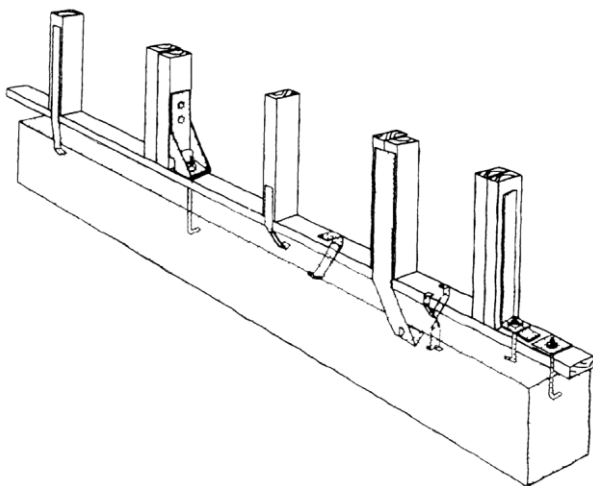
Виды креплений деревянных конструкций к бетонному основанию (SEMCO)
